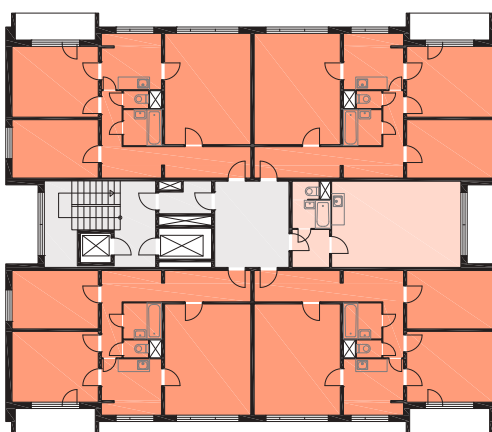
Konstrukční soustava OP 1.13 (Zdroj: panelaky.info)
